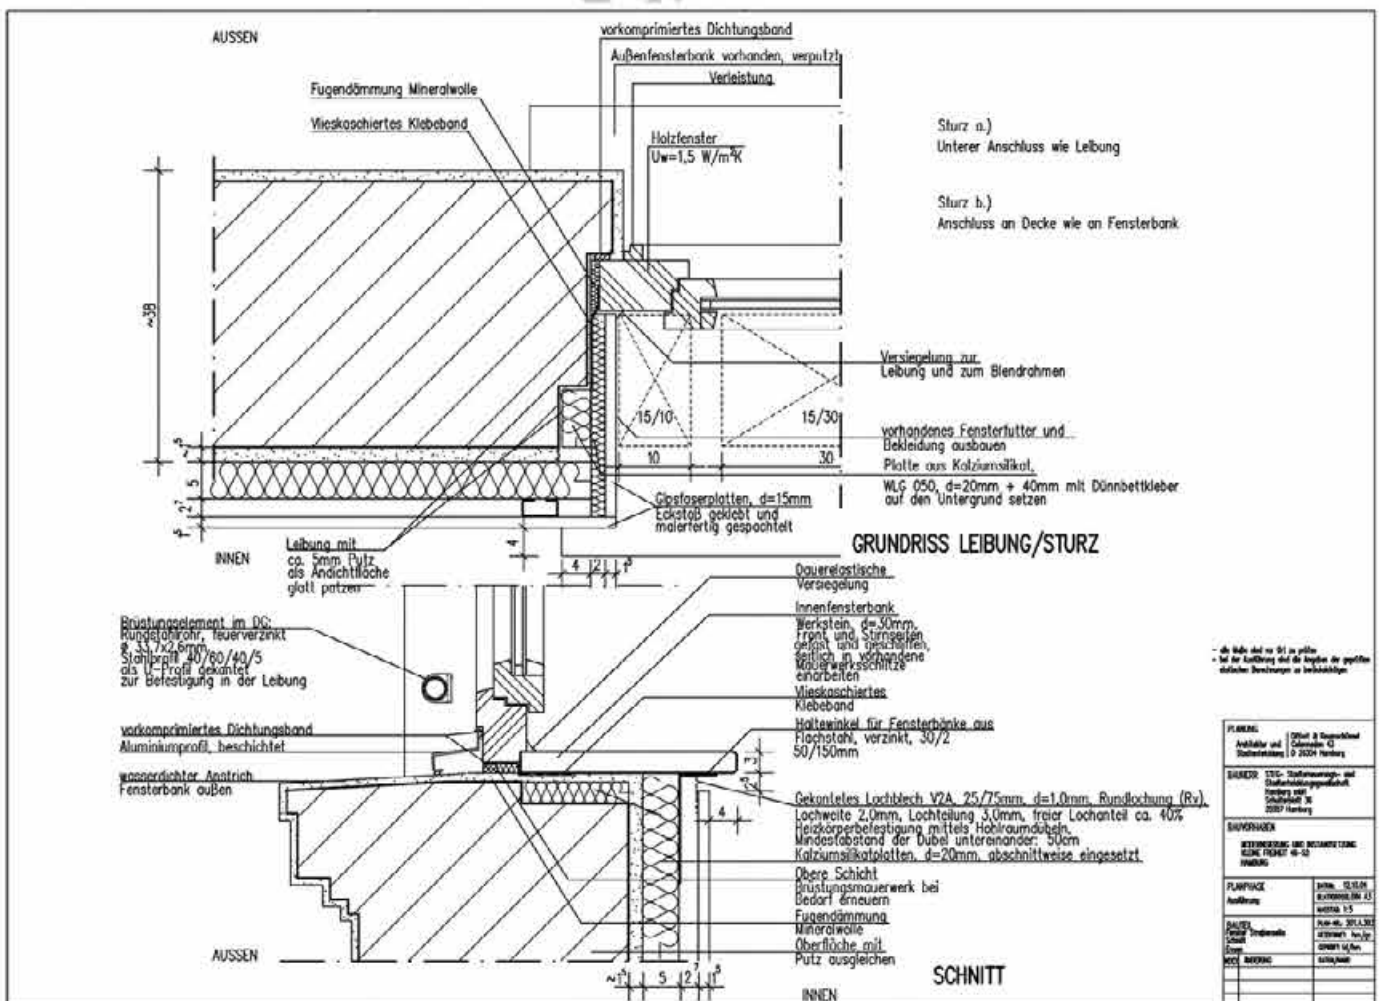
Innendämmung, Detailplanung für Leibung und Sturz
